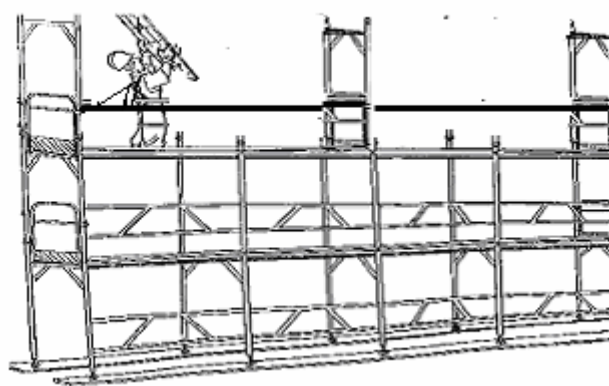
Montaggio e smontaggio con l'operatore collegato con due cordini alla linea di ancoraggio
